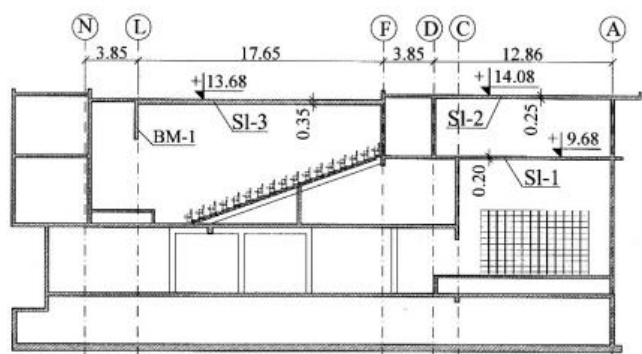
Sección del centro cultural y artístico. [7]
